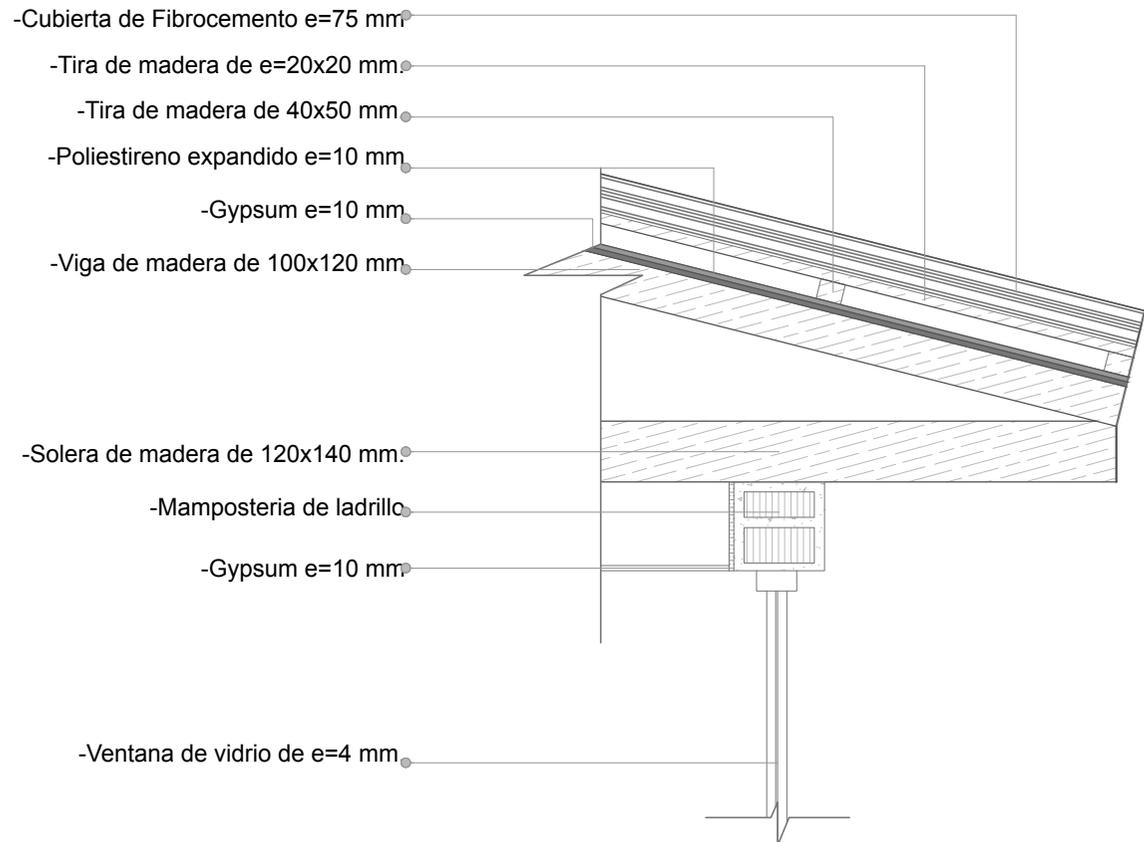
Planos arquitectónicos. Fuente: La autora.
